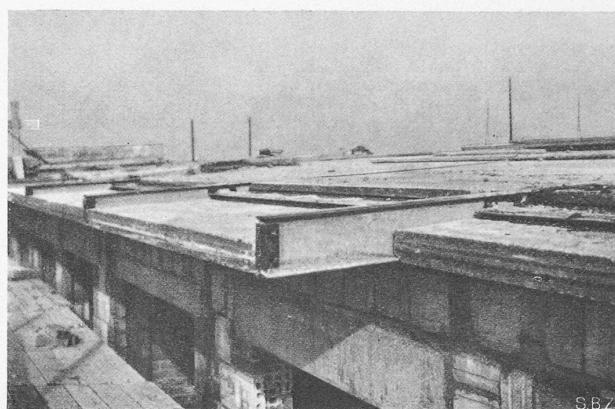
Dachkonstruktion des Stahlskelettbau mit Remy-Bims-Hohldielen.
